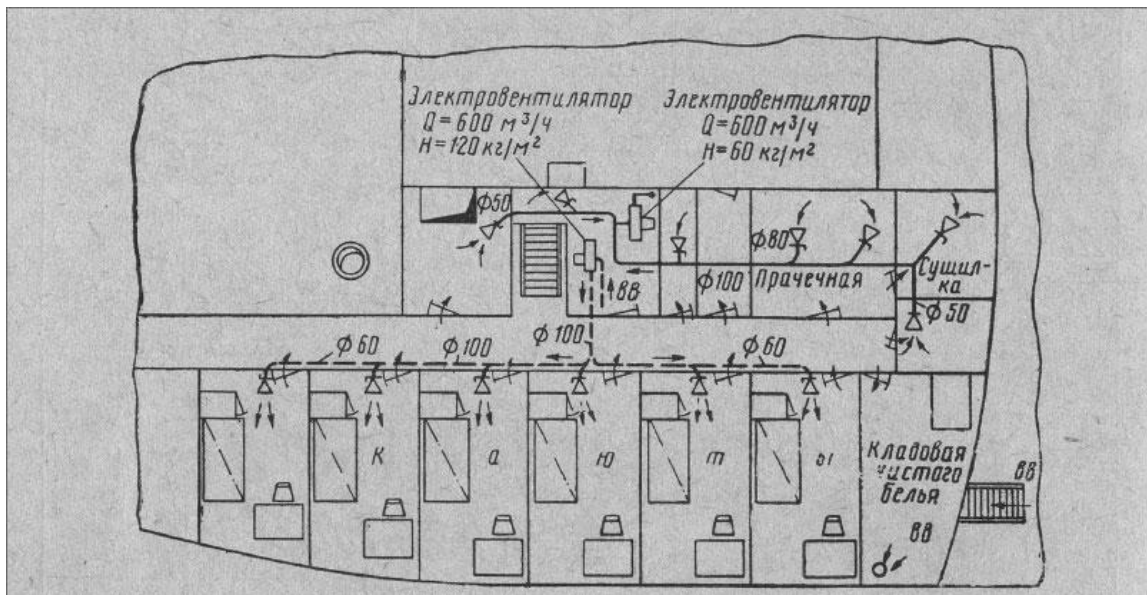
Схема системы смешанной вентиляции для жилых, бытовых и служебных помещений
